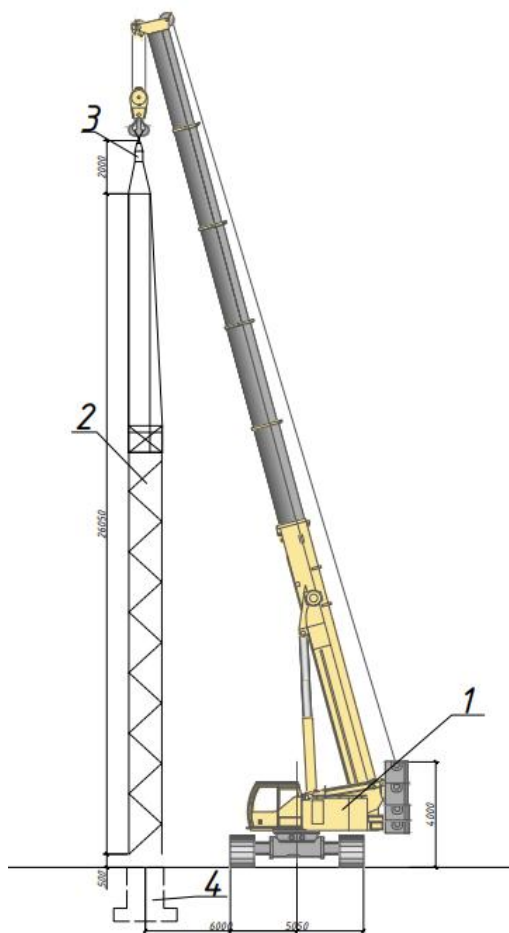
Монтаж колони (1 – монтажний кран; 2 – колона що монтується, 3 – траверса; 4 – фундамент).
